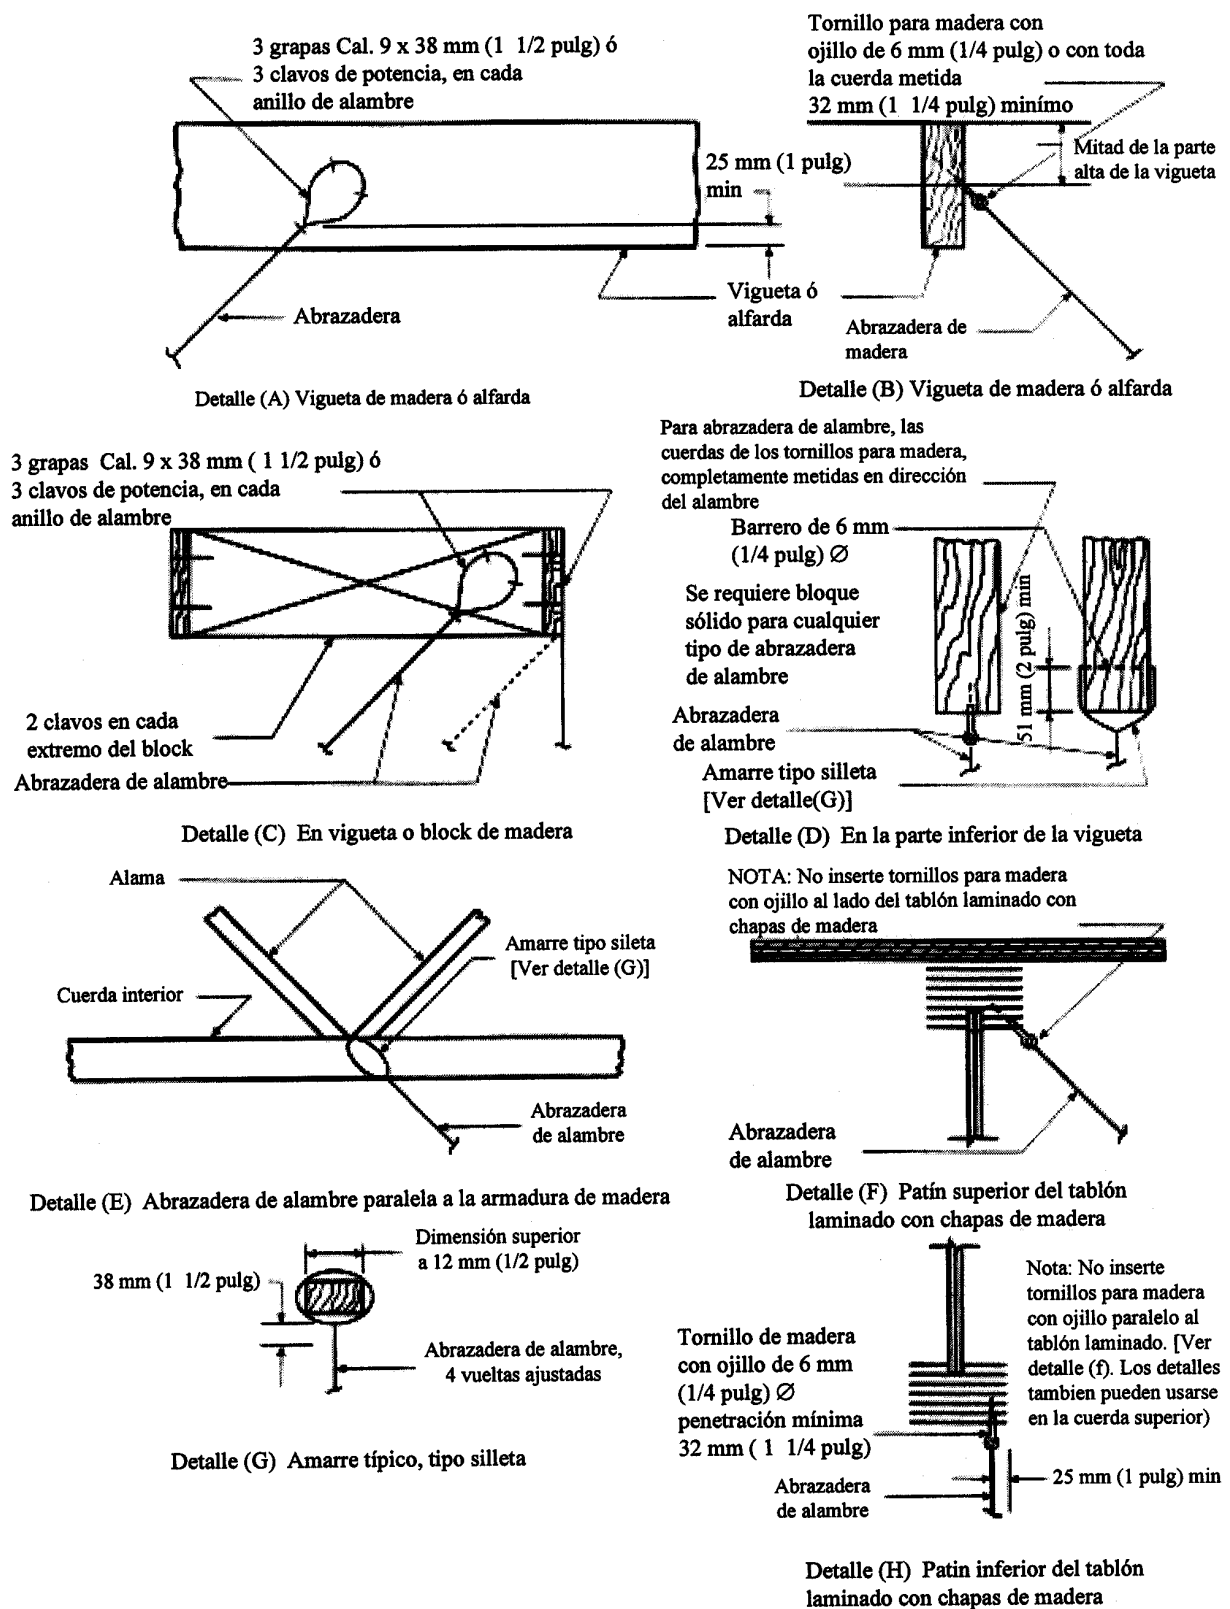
(d) Detalles aceptables - conexiones de alambre a estructuras de madera.
